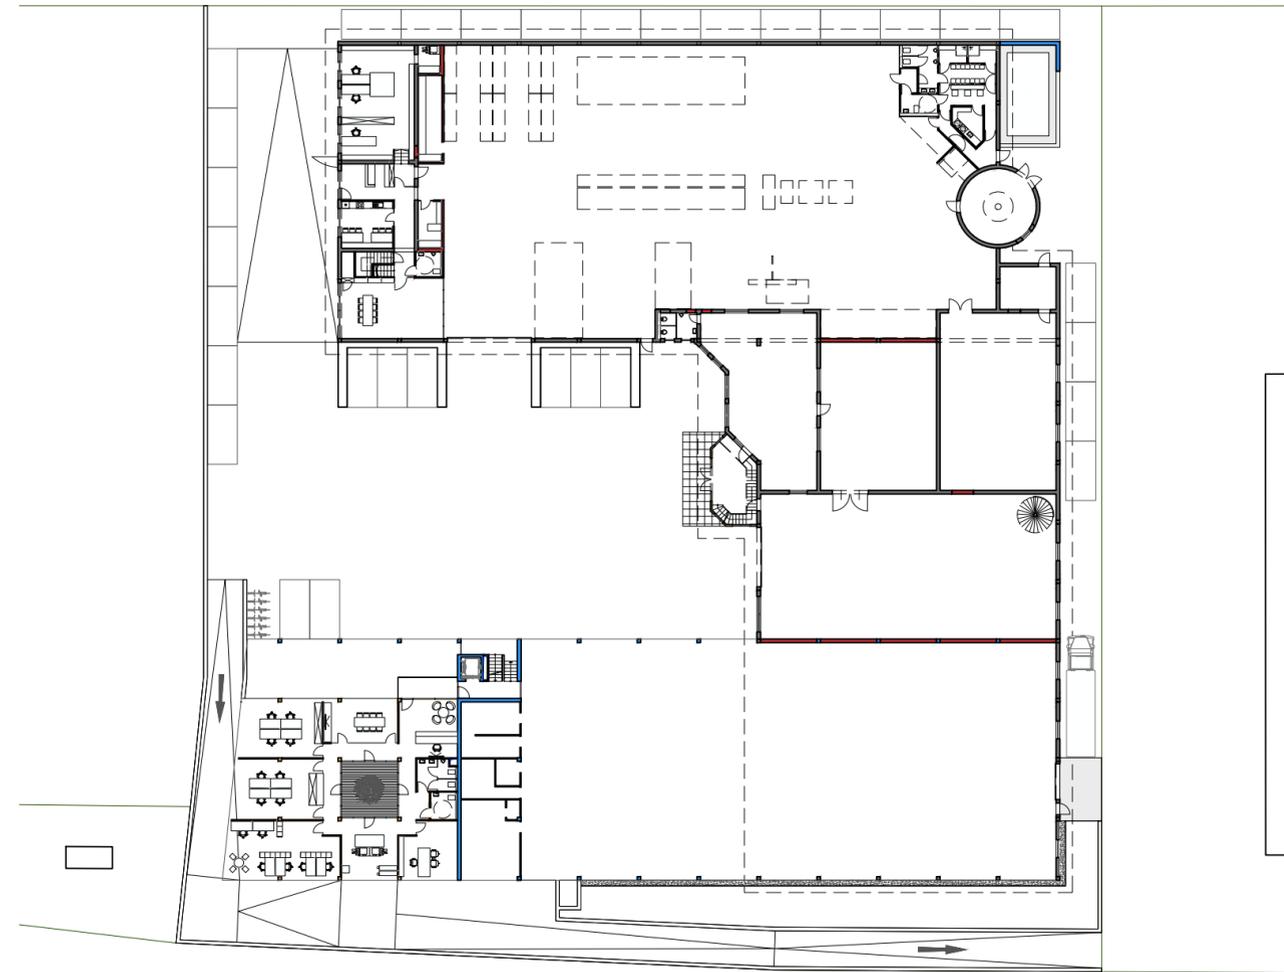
Vorentwurf II - Grundriss Zwischengeschoß
